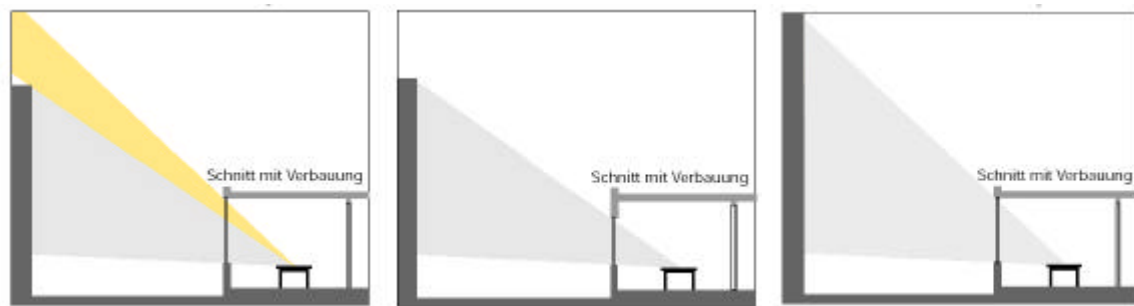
Einfall des Lichtes durch Verbauung⁷
